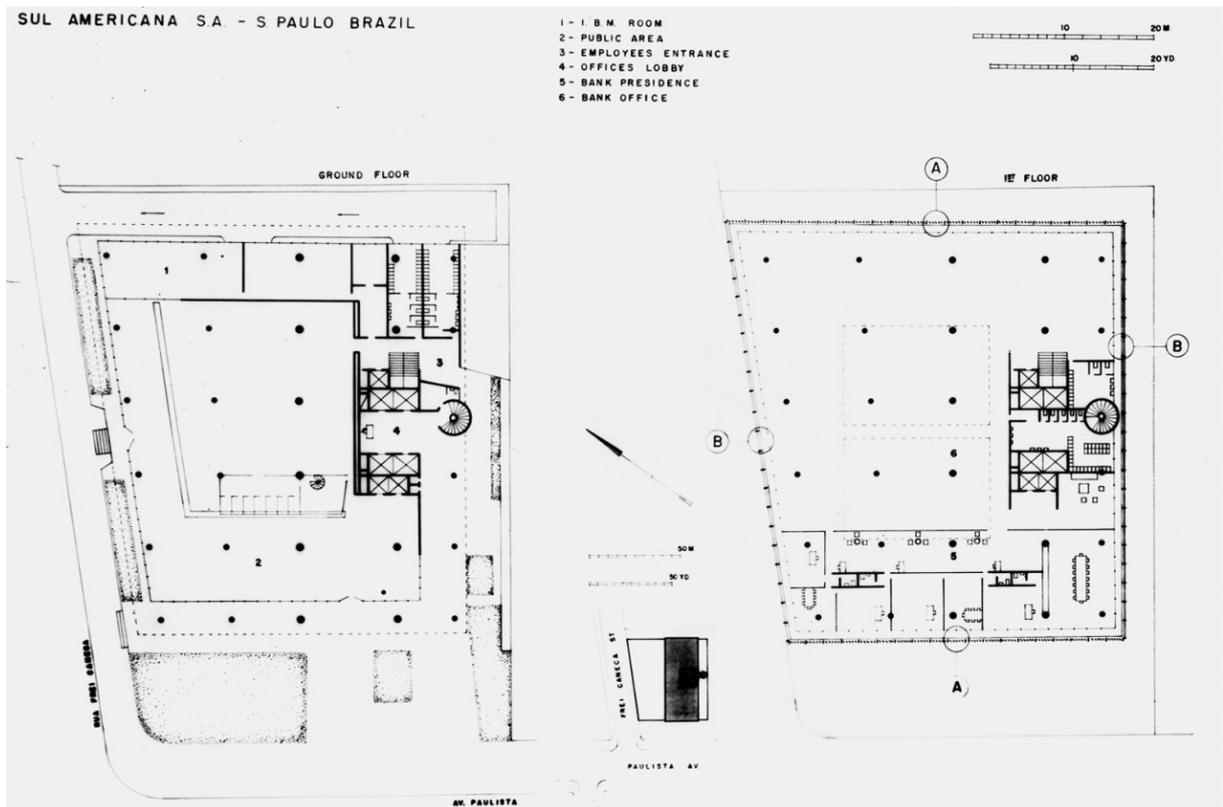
Pavimento térreo e mezanino em 1963. Acervo Digital Rino Levi - FAU PUC Campinas
